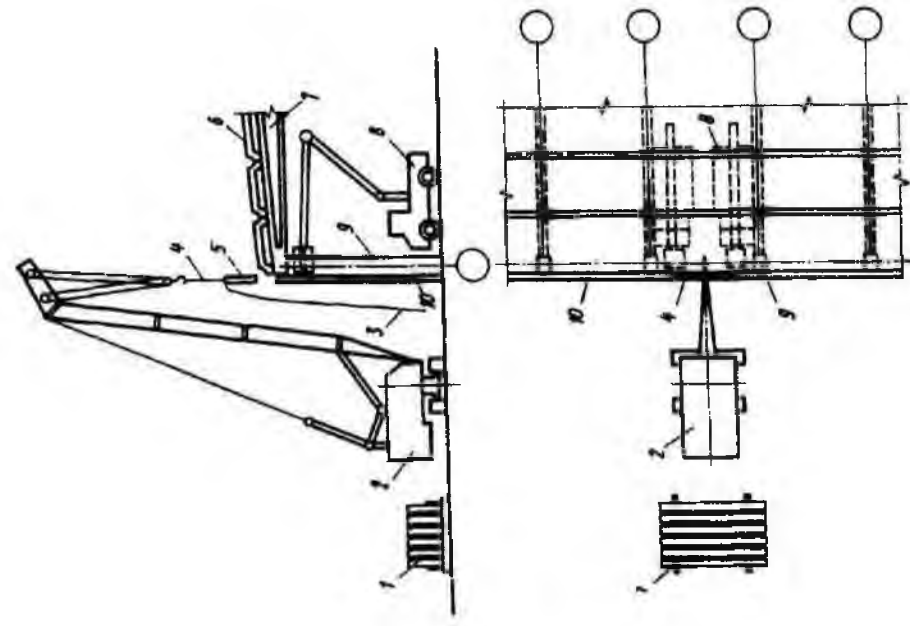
Схемы монтажа фермы пролетом 18 и 24 м и плиты покрытия поперечным методом
